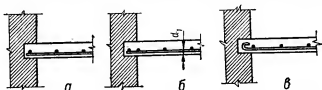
Анкеровка сварных сеток на свободных опорах плит:
